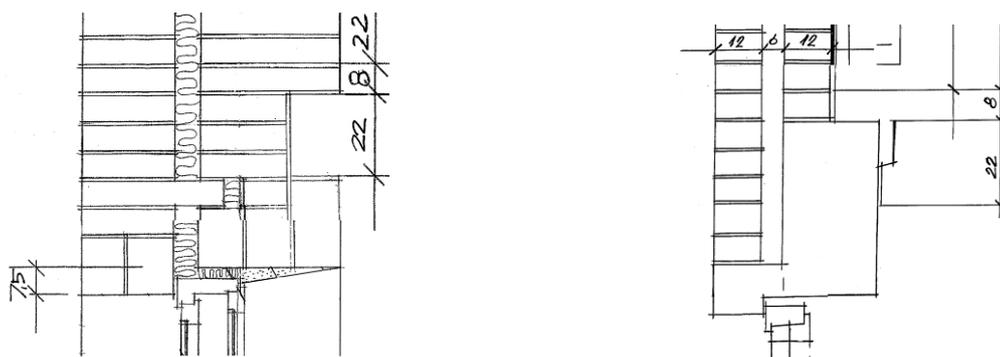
Решения для перемычек внешних стен: монтируемые железобетонные перемычки (слева) и железобетонная балка (справа).
